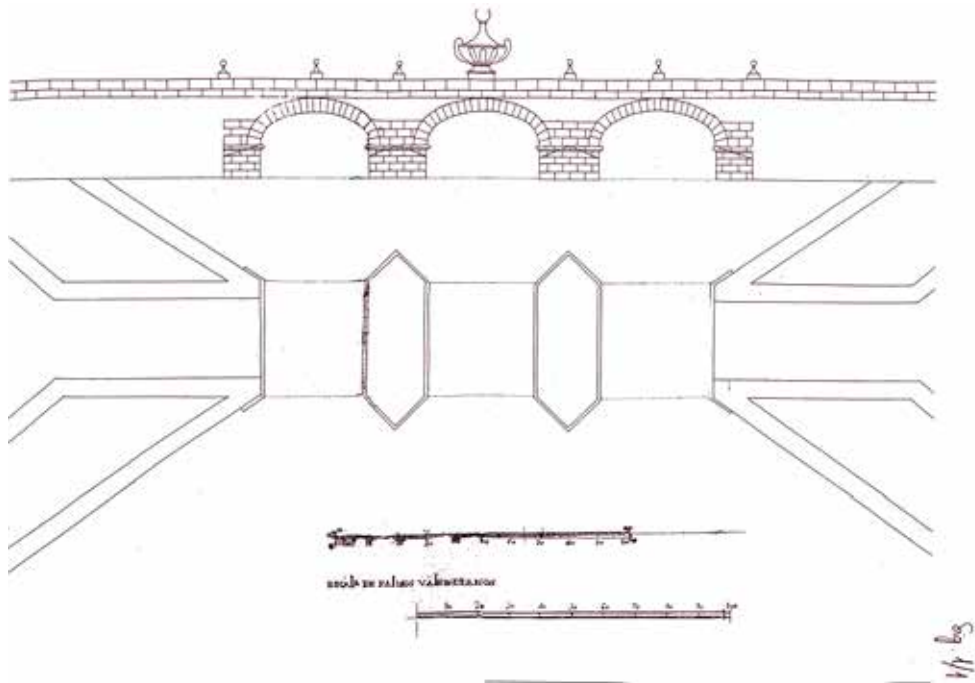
Planta y perfil del puente de piedra. Expediente (1772-1779)
